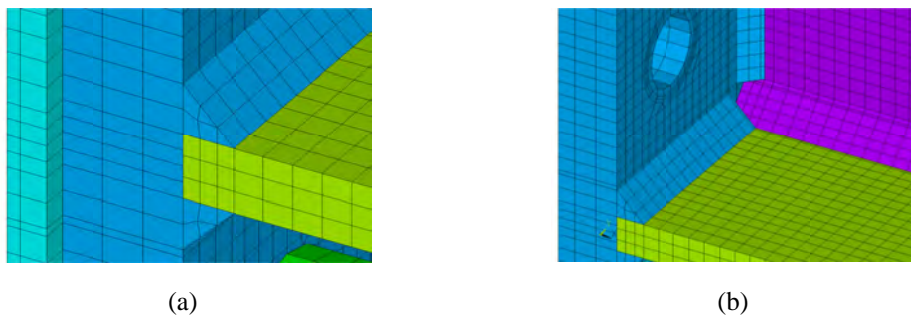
Detalle de las soldaduras: (a) ala superior de la viga; (b) ala inferior de la viga.
